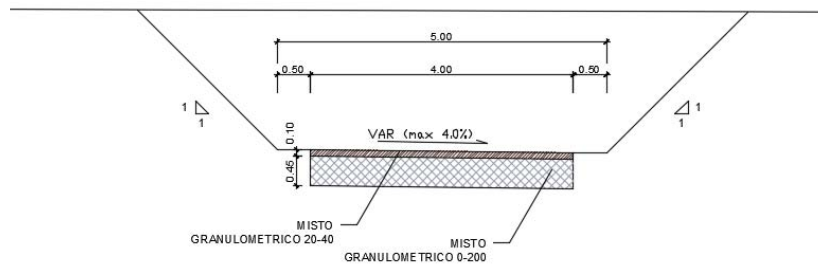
Sezione tipo in trincea carreggiata 4 m.
